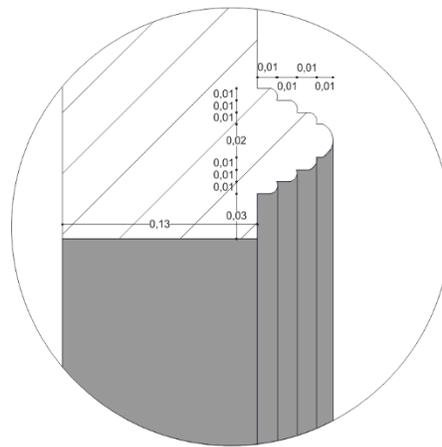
Detalle 4, detalle rosetón, Estación del ferrocarril Sur.
